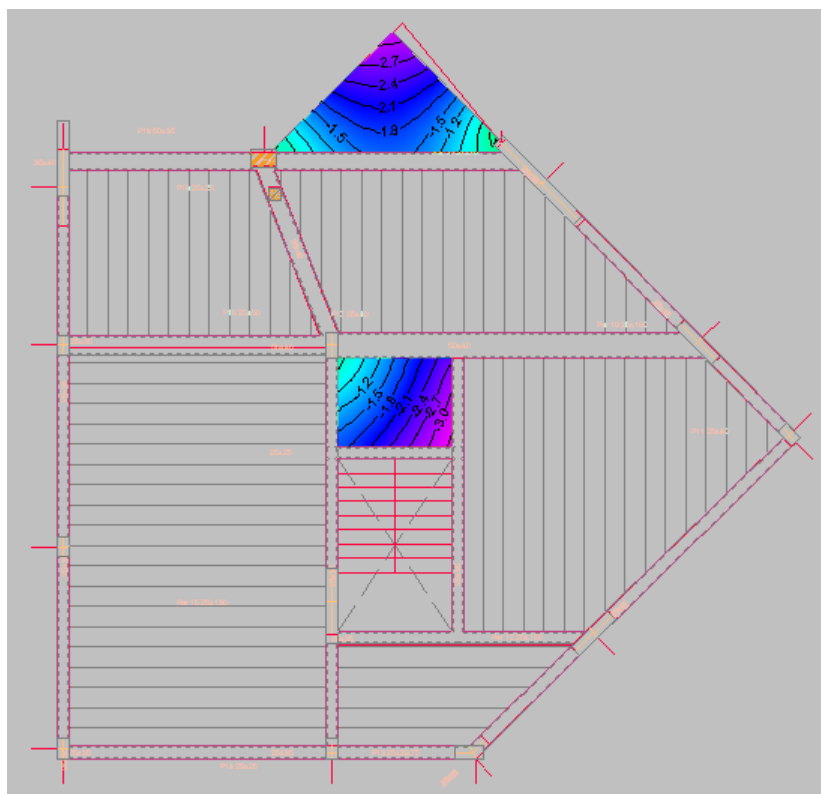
Deformada da laje do teto do Piso 0, (mm).
